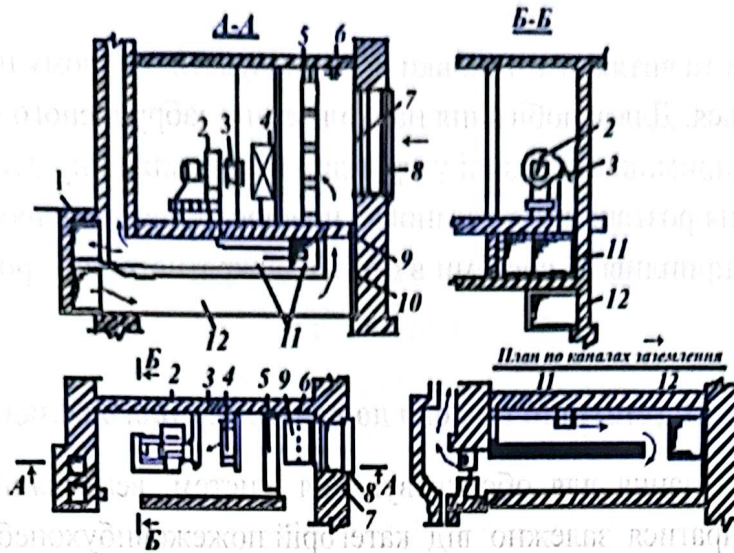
Припливна вентиляційна установка в приміщенні першого поверху будівлі:
